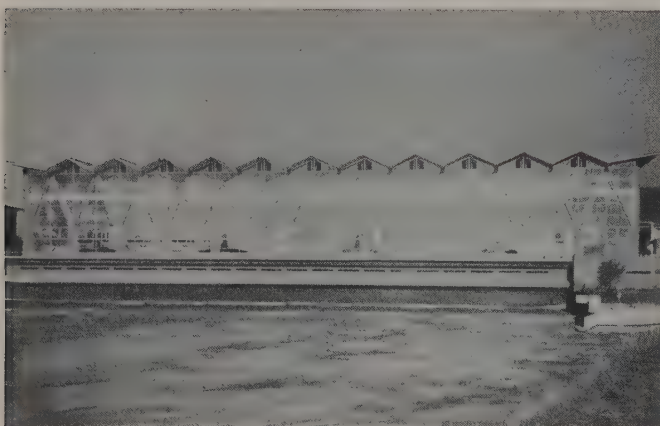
Zickzackfaltdach aus Ort beton mit schlaffer Bewehrung (Birsfelden/Schweiz)
